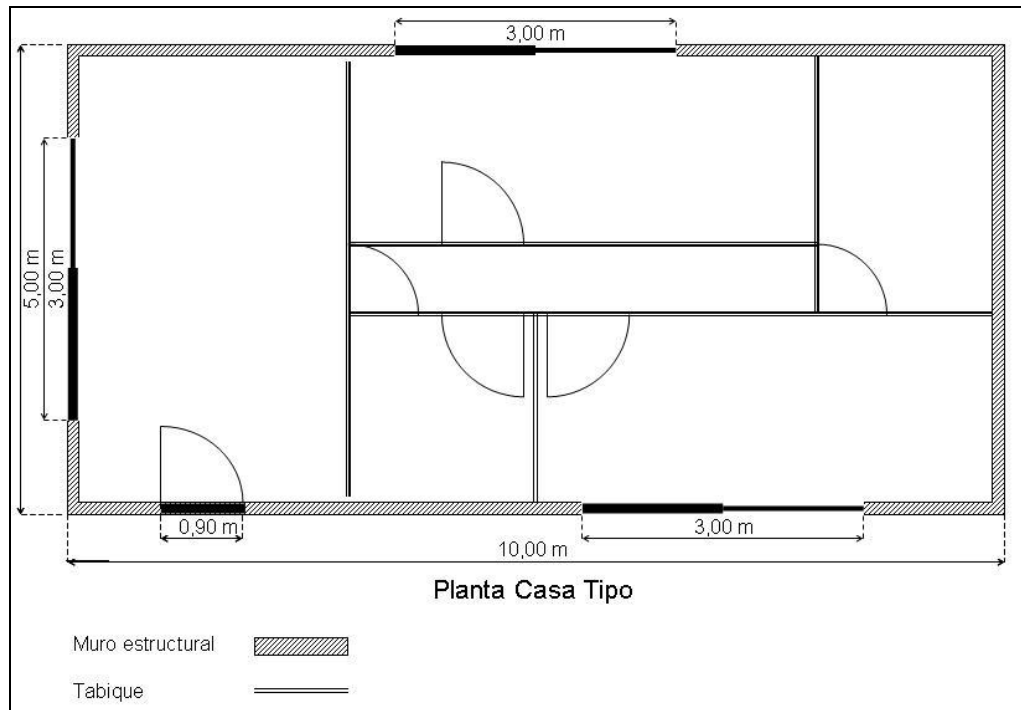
b. Planta de la vivienda tomada como ejemplo, casa básica de 1 piso.
